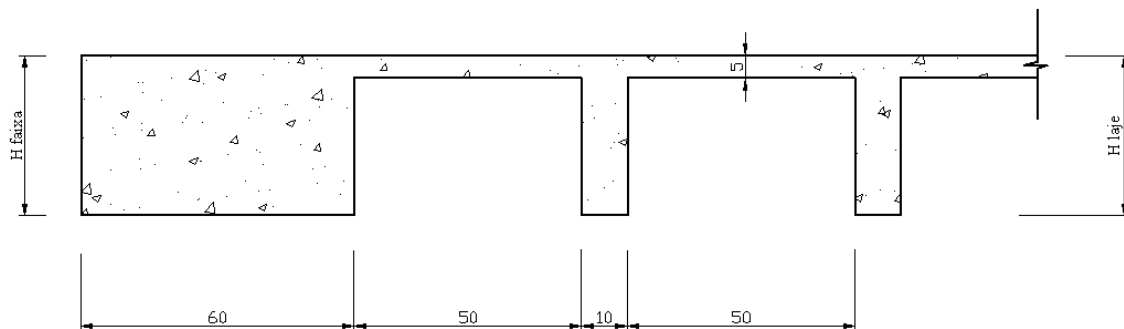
Corte com detalhe da faixa de apoio. Dimensões em cm.
